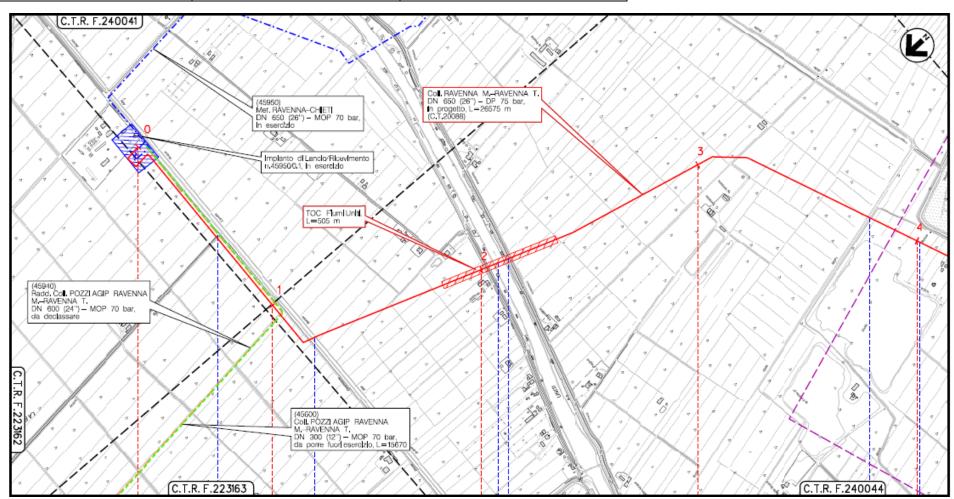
Stralcio planimetria CTR con localizzazione dell'area di intervento
